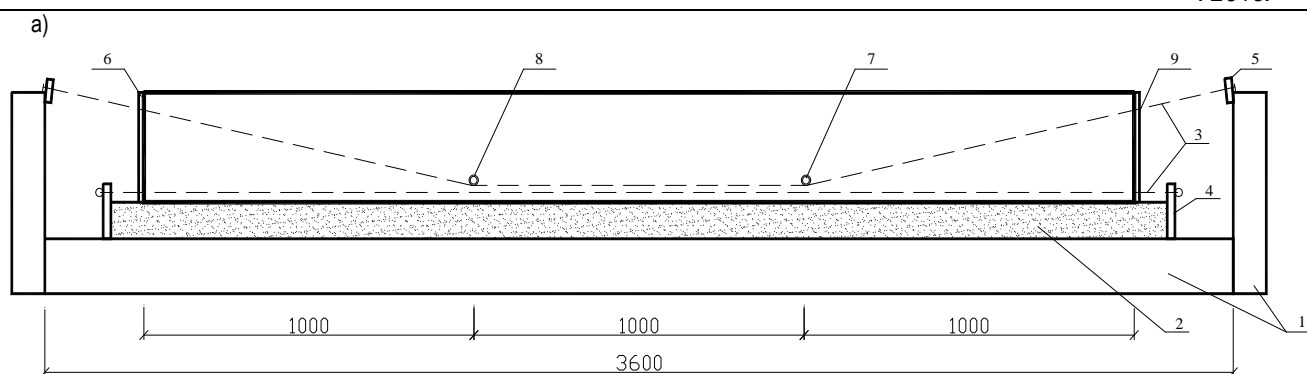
Конструкция экспериментальной железобетонной балки с отогнутой предварительно напряженной арматурой
